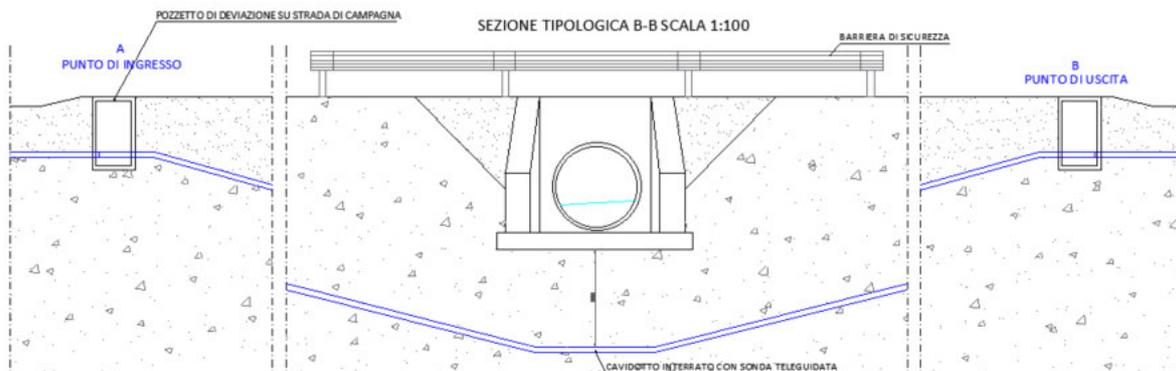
Sezione tipologica dell'attraversamento in TOC al di sotto del rilevato stradale
